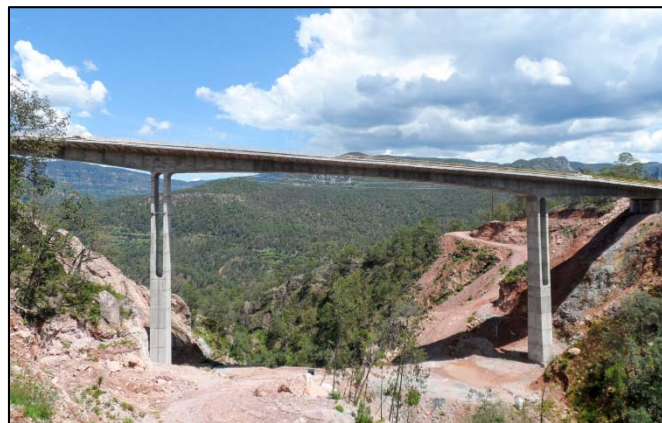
Puente en estudio ubicado en la carretera Durango – Mazatlán. (www.cfcsl.com)
